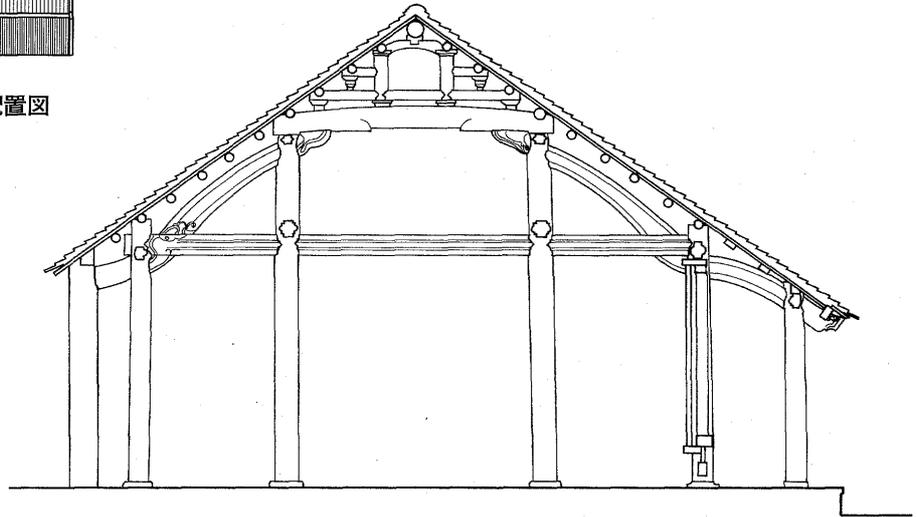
Ha Van Lam邸 主屋 断面図 1:75
